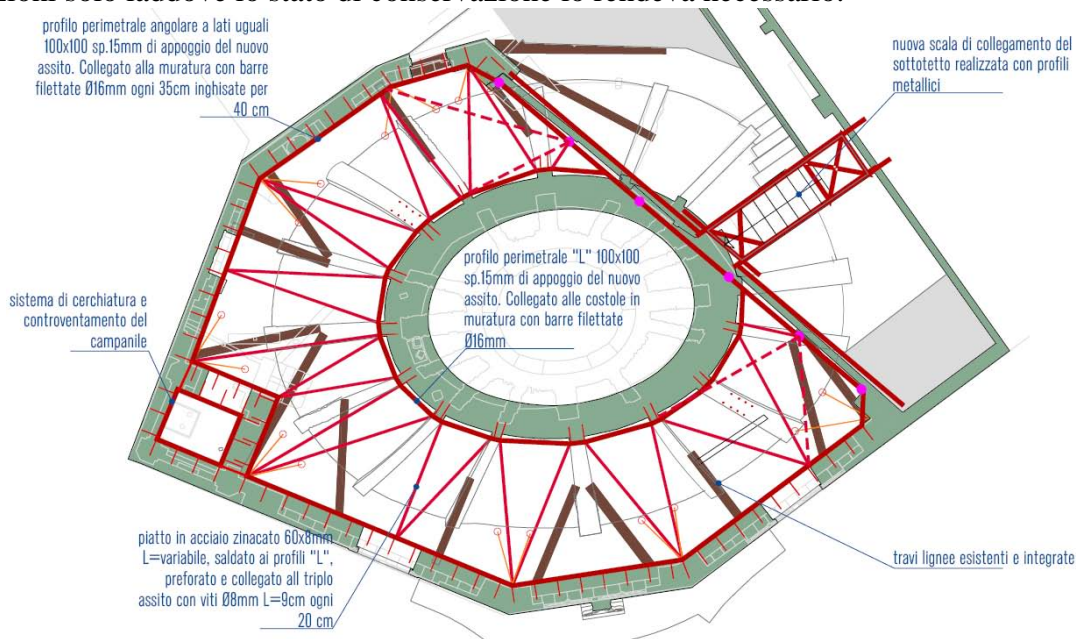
Orditura del solaio di sottotetto. Travi lignee principali, profili "L" perimetrali, bandelle in acciaio a raggiera.
